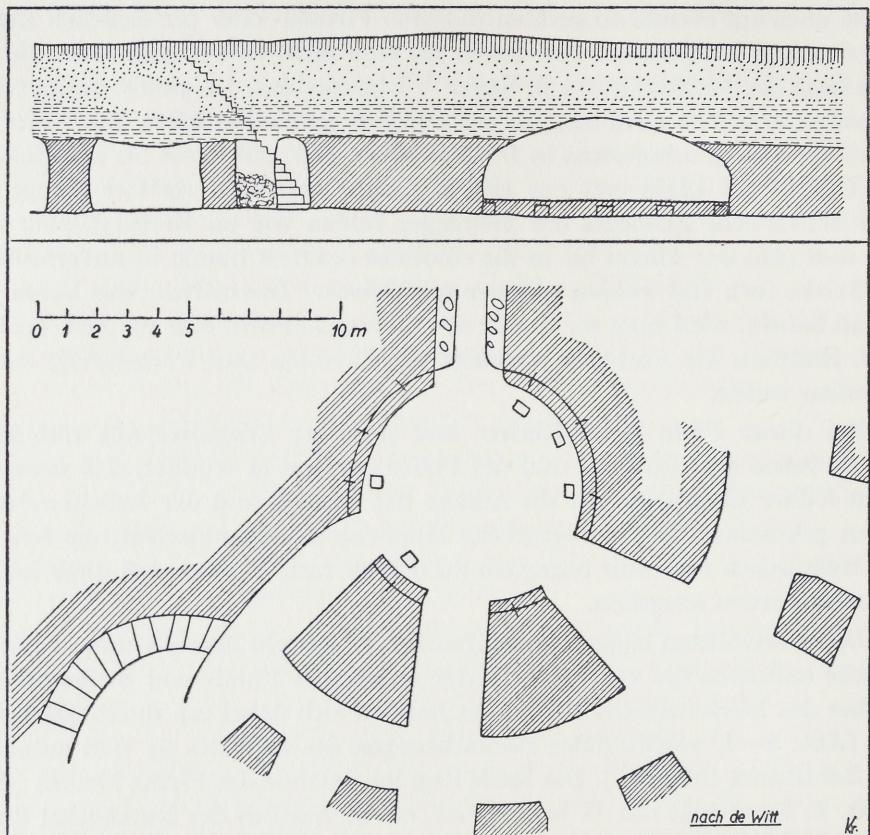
Untertagebau. Plan und Schnitt (nach de Witt).
